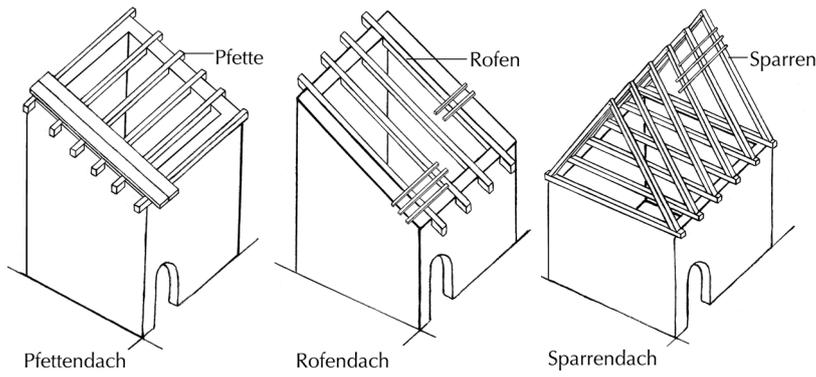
Beispiele für die drei Grundsysteme der Dachgerüste.
